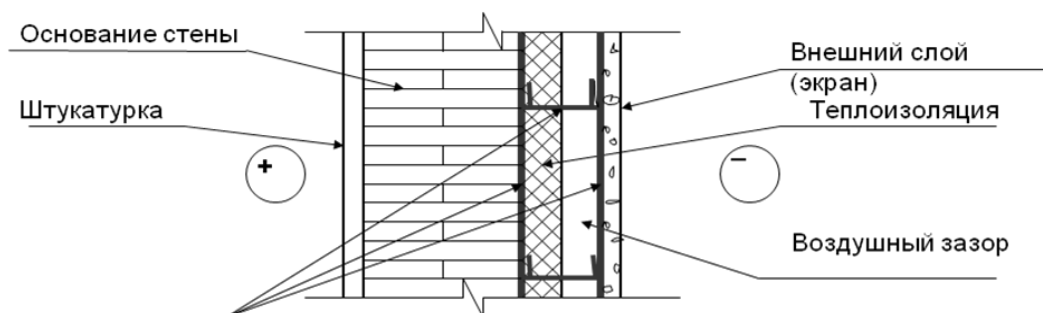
Конструкция фасадной системы с вентилируемым воздушным зазором
